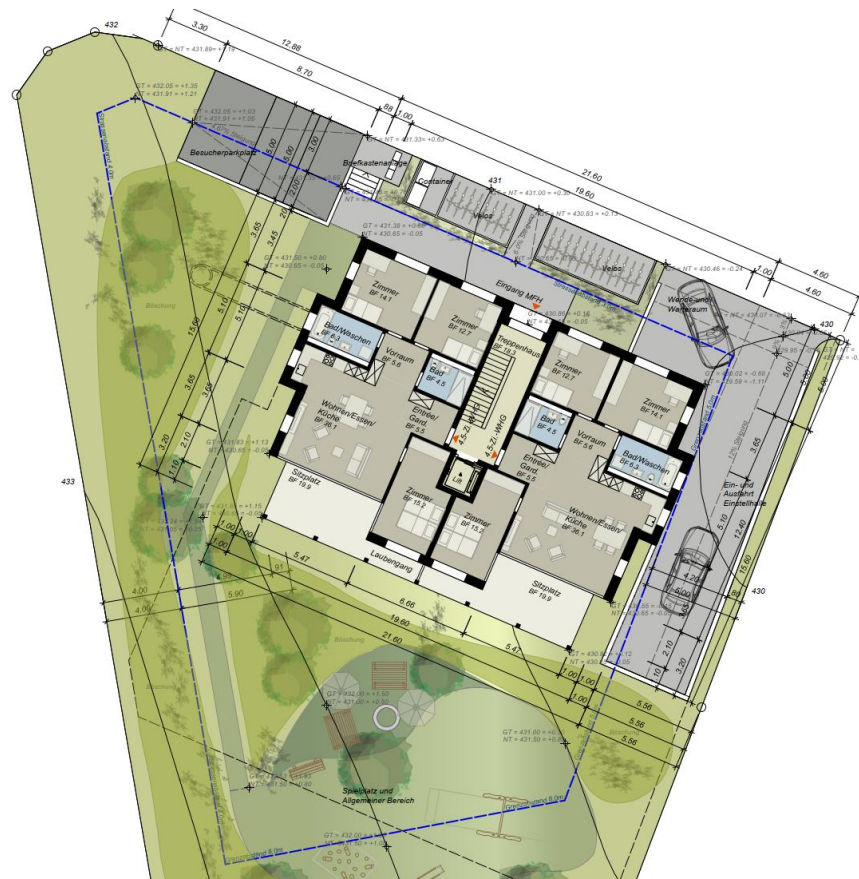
Überbauung Oberdorf, Grundriss Erdgeschoss und Umgebung, Bischoff & Partner Architekten AG
